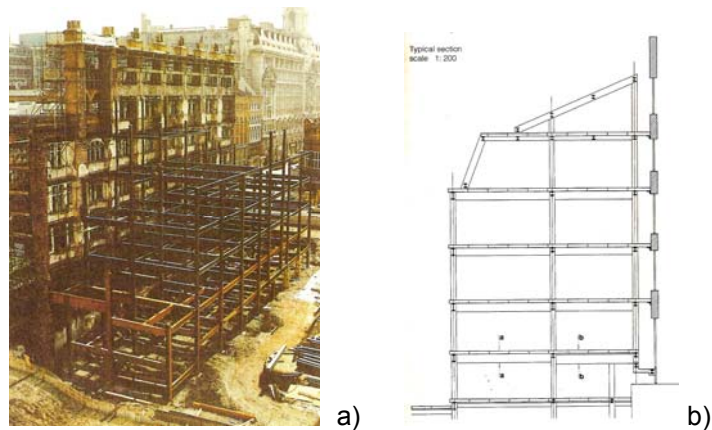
Encontro da fachada antiga e a nova edificação.
